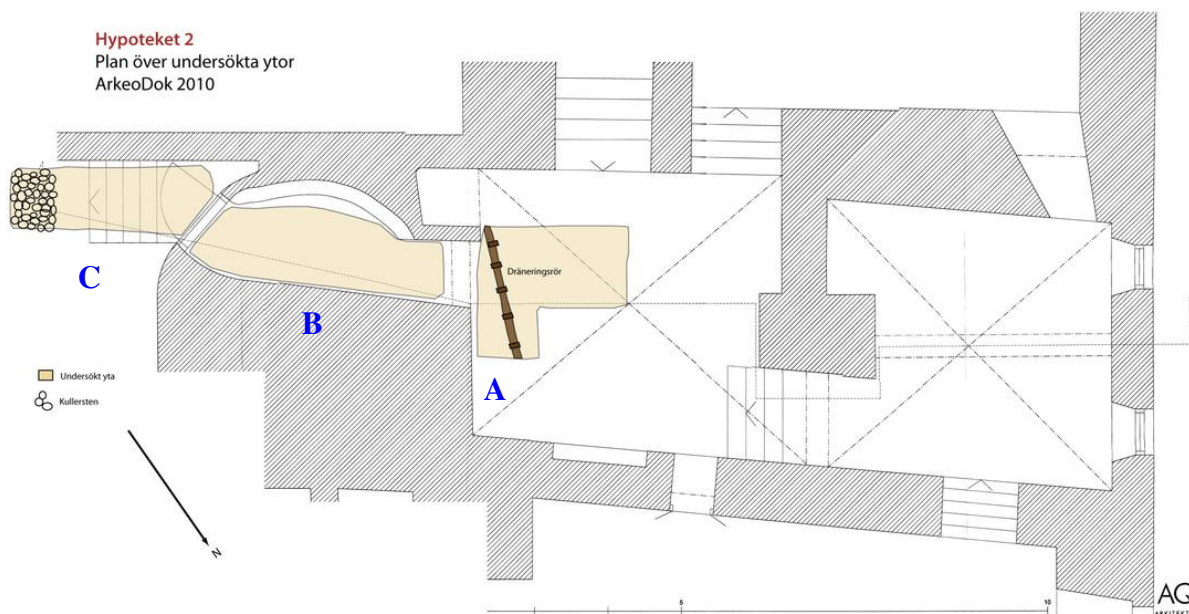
Plan över provschakten. Se även bifogad bilaga .
